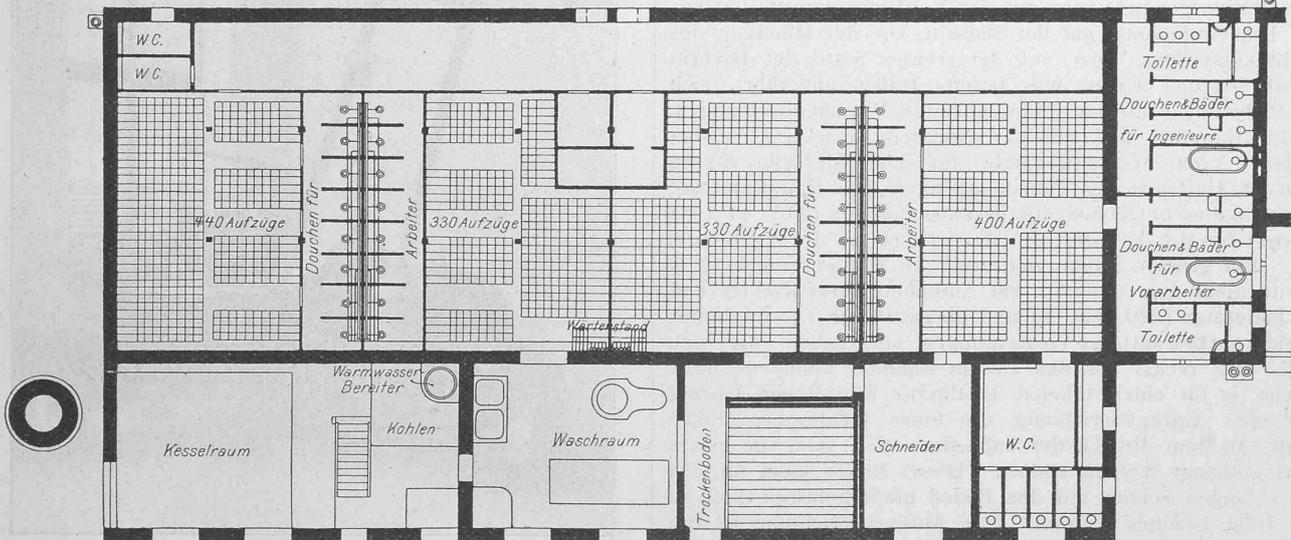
Stationsgebäude auf der Nordseite. — Grundriss der Baderäumlichkeiten und der Wascherei. — Masstab 1 : 250.
